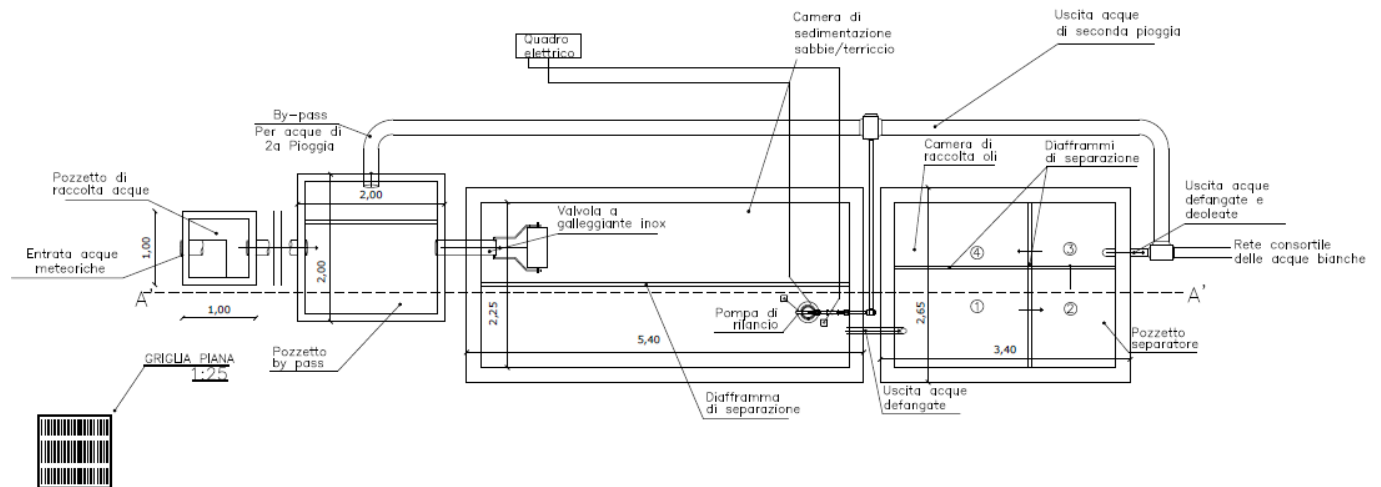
Rappresentazione in pianta dell'impianto di trattamento previsto
